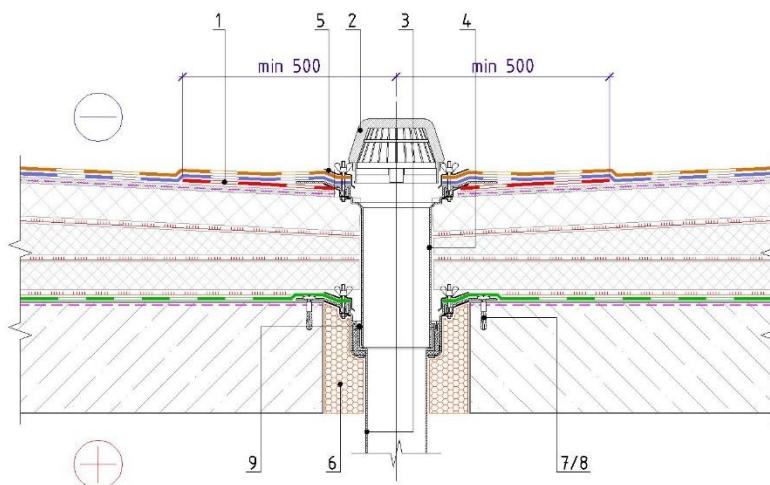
Схема расположения полотен нижнего слоя водоизоляционного ковра в зоне водоприемной воронки
